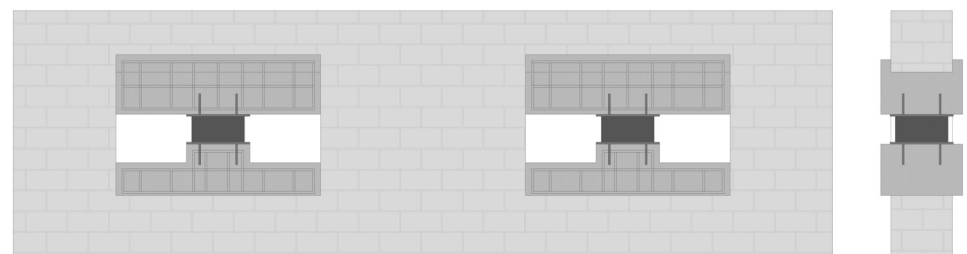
Fase di intervento n. 2, disposizione delle armature e getto del poggolo i c.a.
